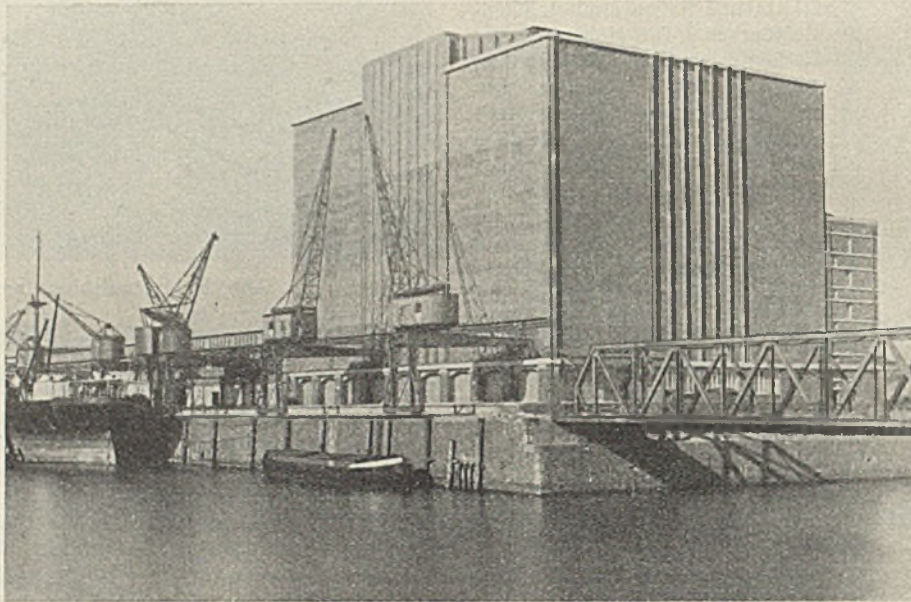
Ansicht von der Wasserseite mit Ladeanlagen.
